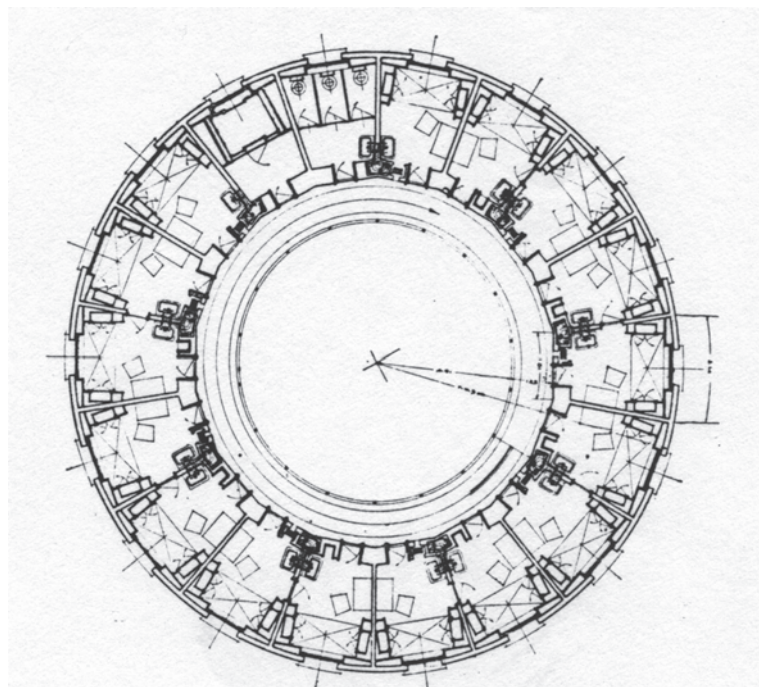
Fiat-Hotel „La Torre“: Grundriss Rampengeschoss
